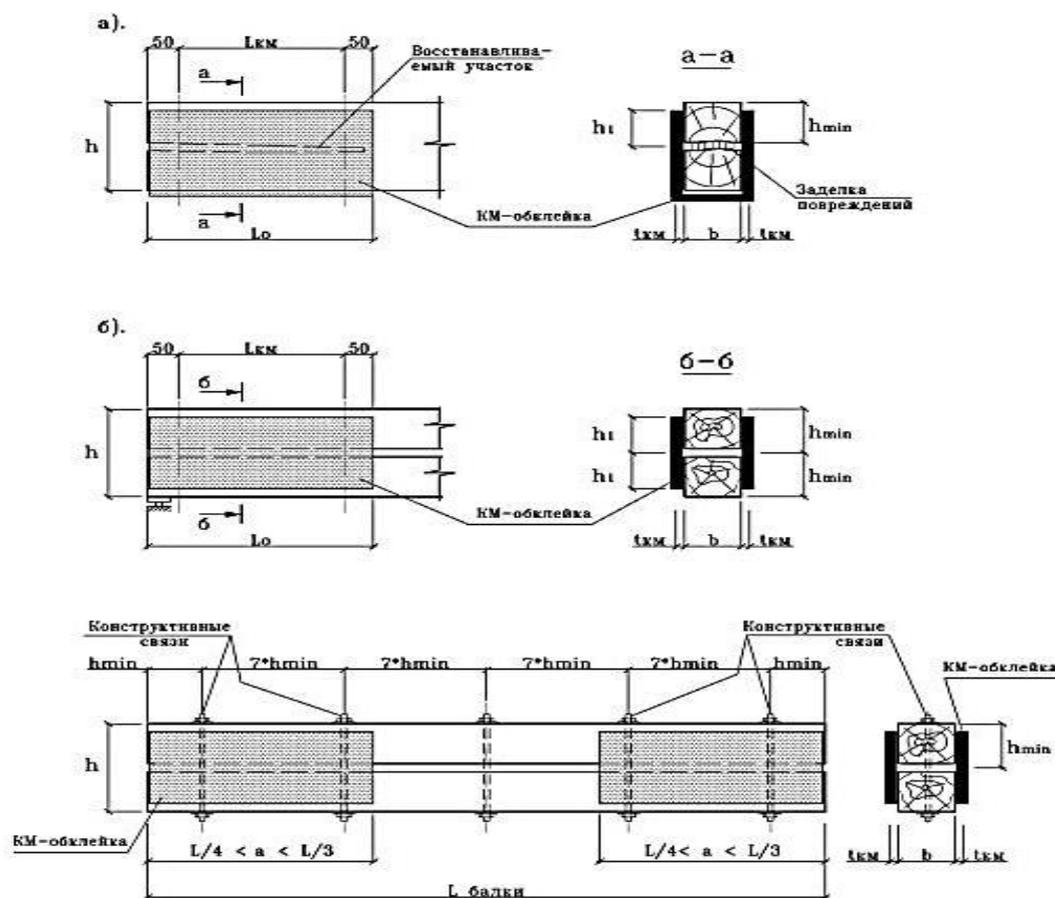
Расчетная схема соединения «КМ-обклейка»: а — при восстановлении существующих деревянных конструкций; б — при создании новых деревянных конструкций составного сечения
